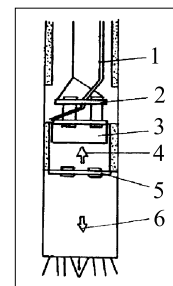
Паралельна схема проходки ствола: 1 – бетонопровід; 2 – прохідницький поміст; 3 – пересувна опалубка; 4 – напрямок кріплення; 5 – натяжна рама; 6 – напрямок проходки.
